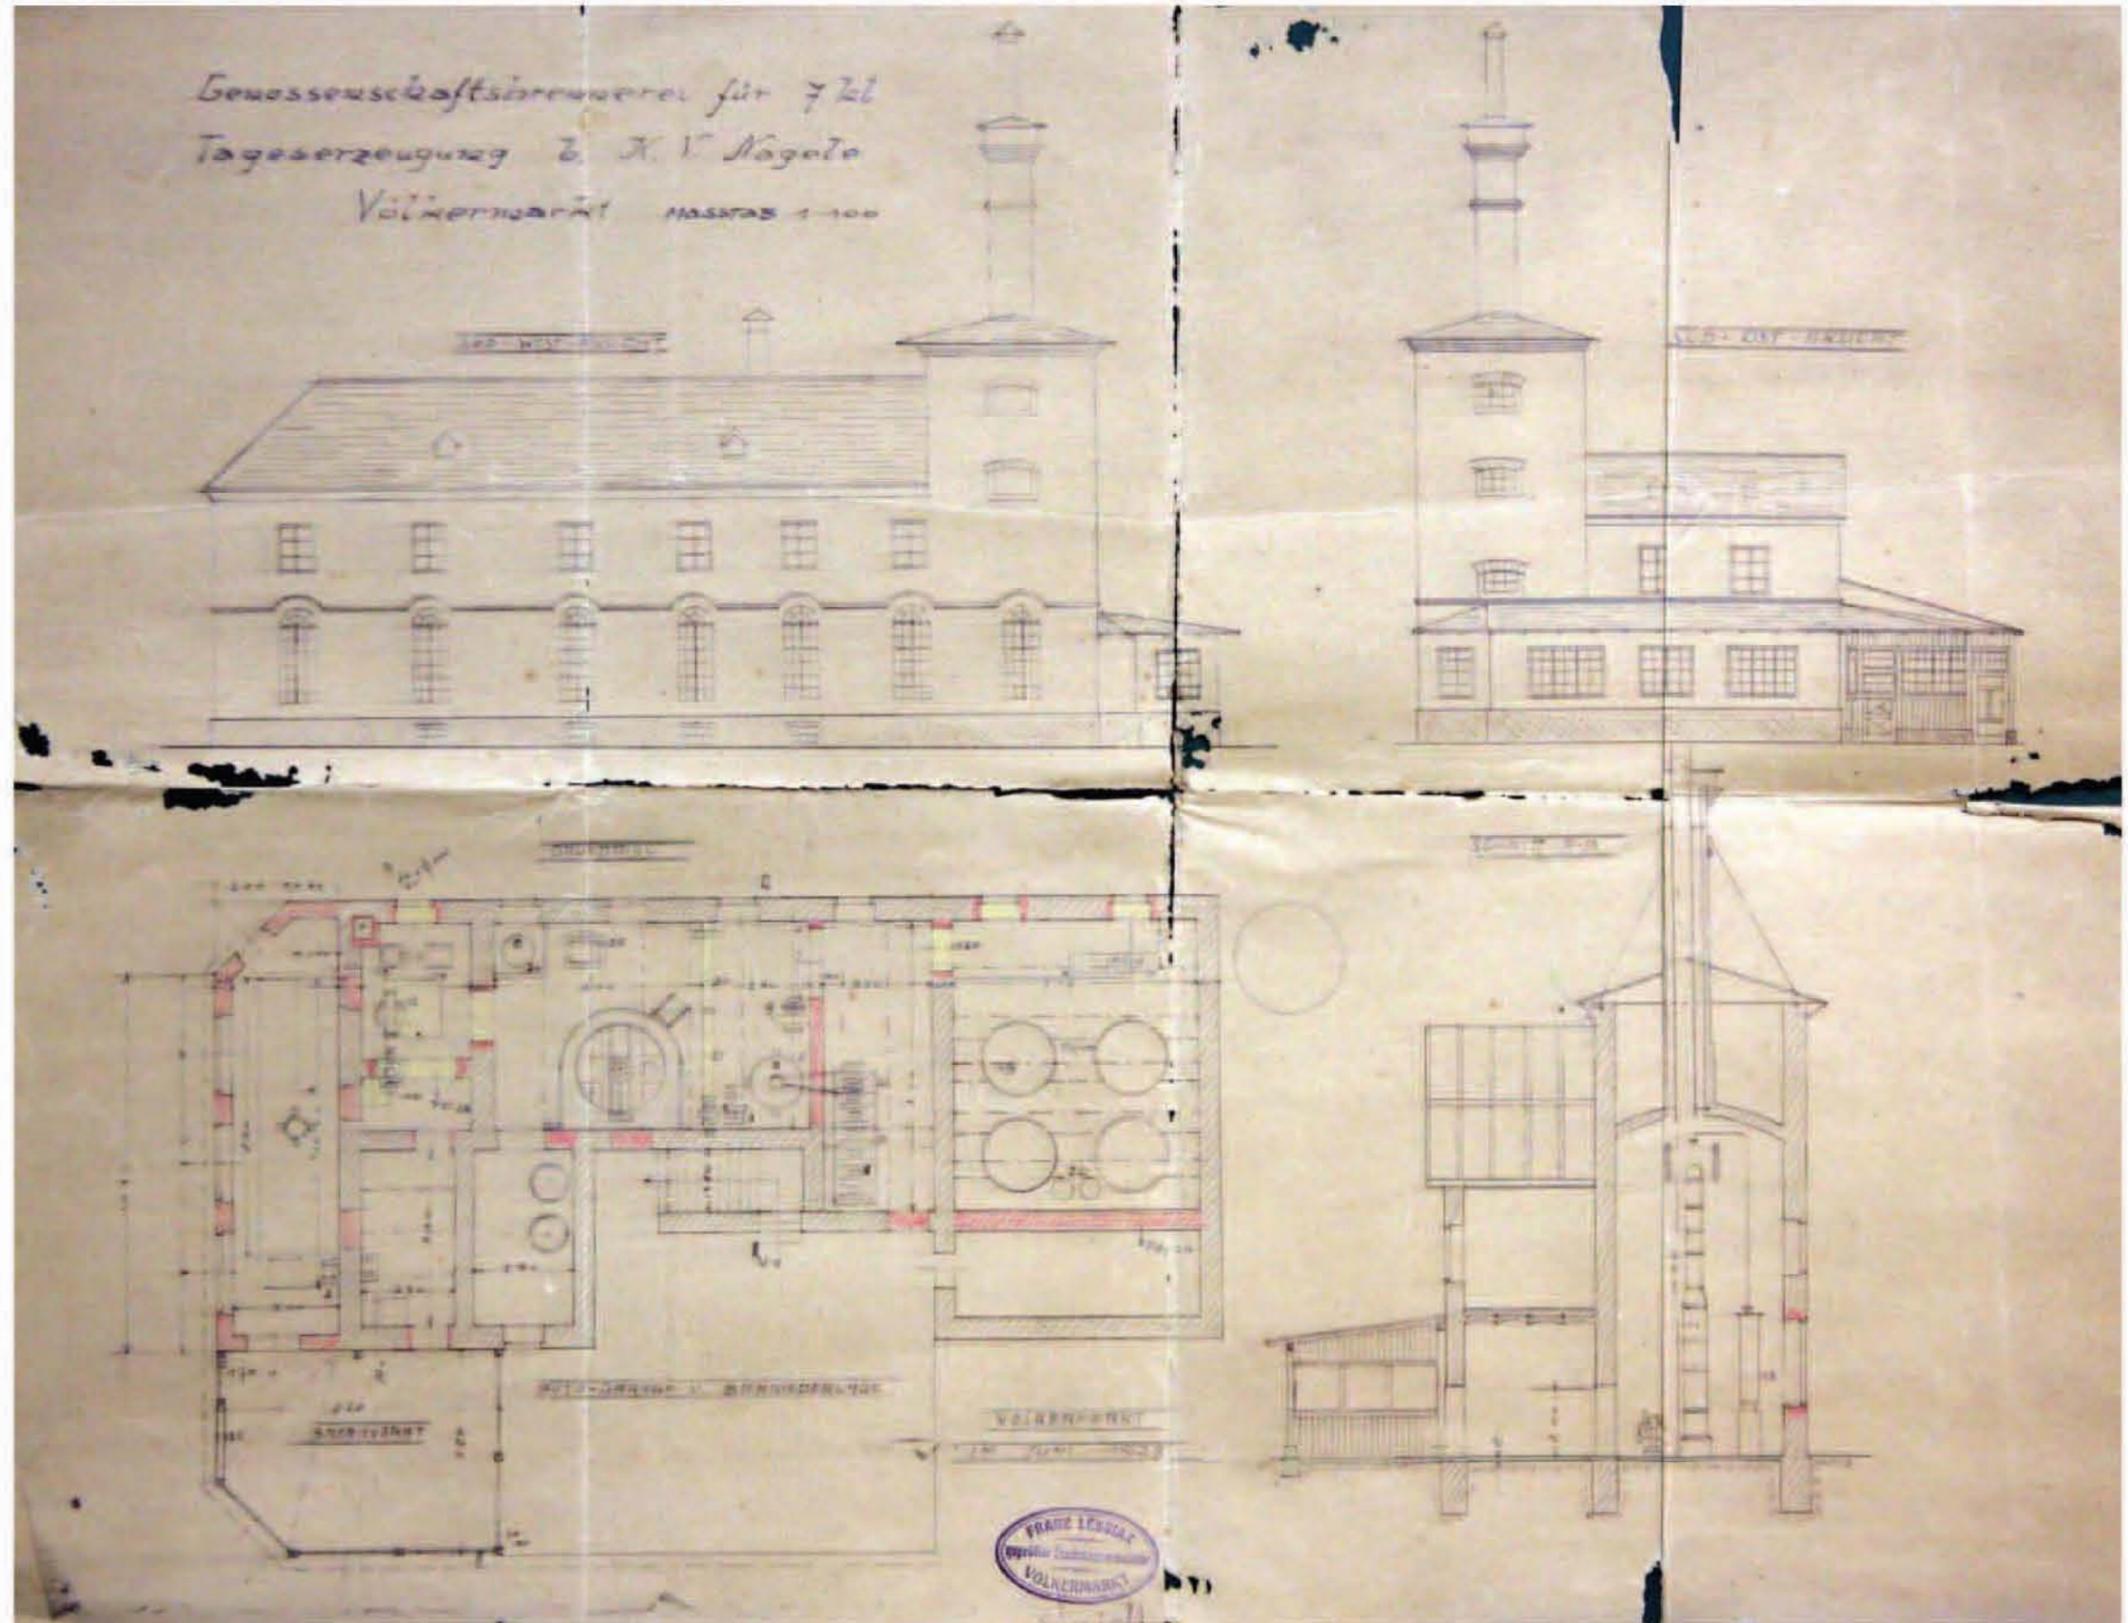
Nord- und Ostansicht, Einrichtung Erdgeschoss und Schnitt des Brauereigebäudes
